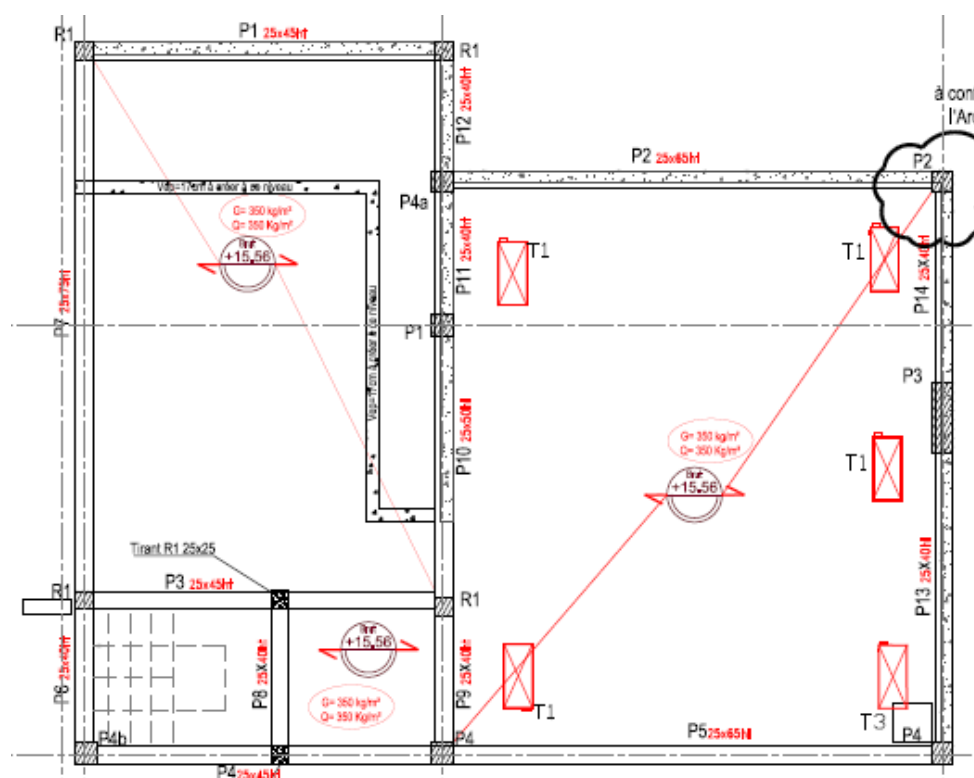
PLAN DE COFFRAGE DALLE PLEINE JOINT 23 PH R+3
